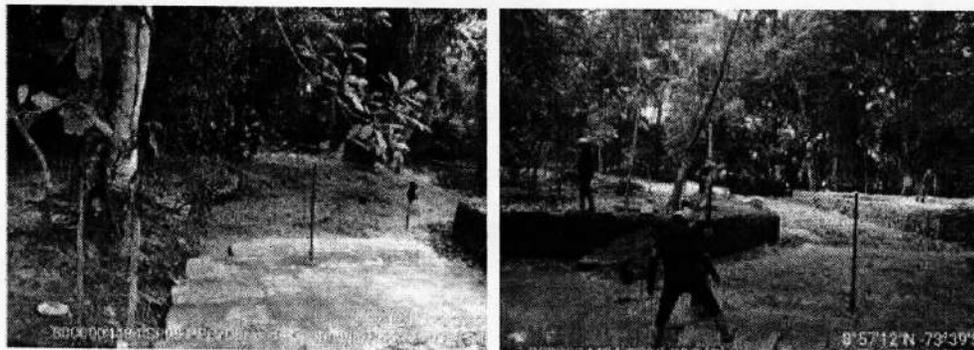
Construcción de canales en saco de suelo cemento en fondo de quebrada La Morrocuya.
